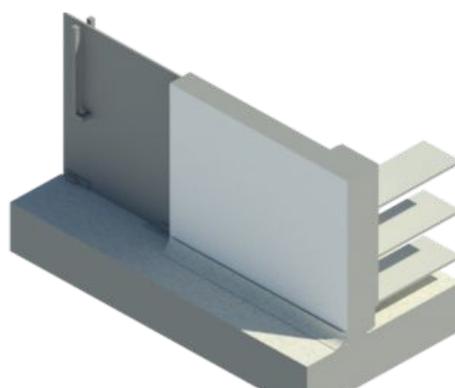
Sección de laboratorio donde se cuenta con un muro flexible.
